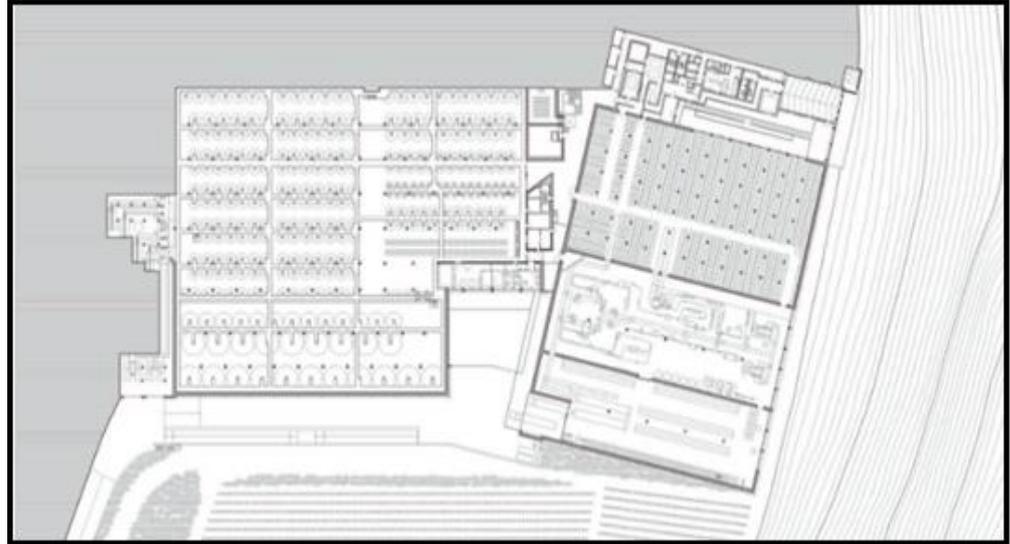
Planta Primer Sótano – Fuente: archdaily.pe
